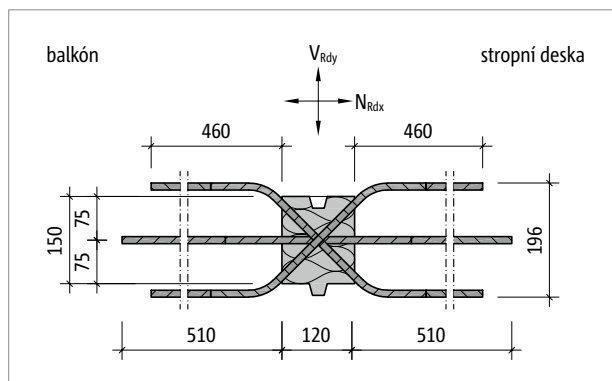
Schöck Isokorb® XT typ HP-VV1-NN1: Půdorys prvku
